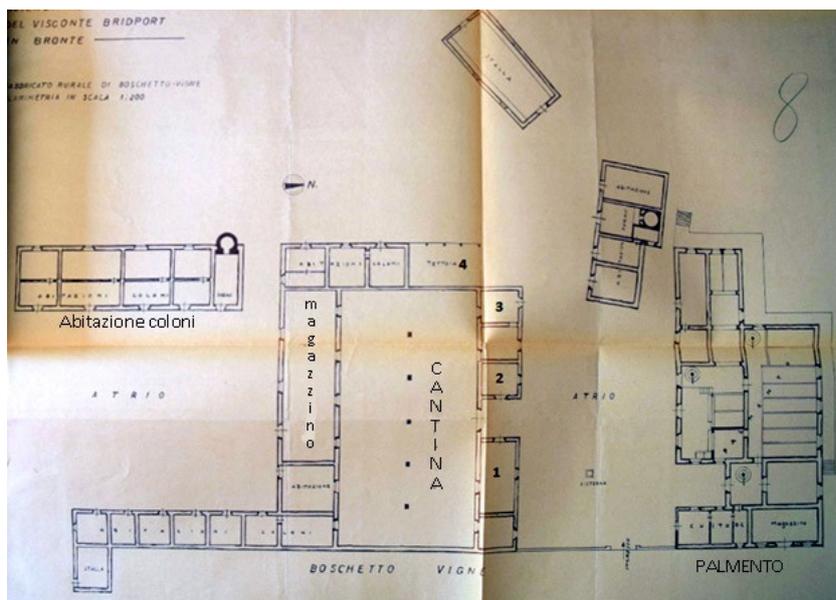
Planimetria del complesso di Boschetto Vigne (1970-80)
